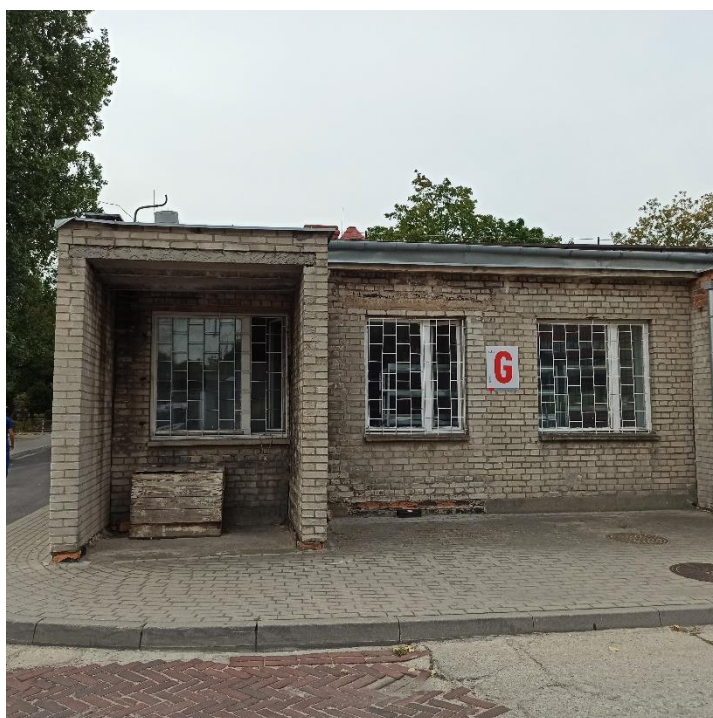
Elewacja wschodnia – brak tynku zewnętrznego, zawilgocenie
